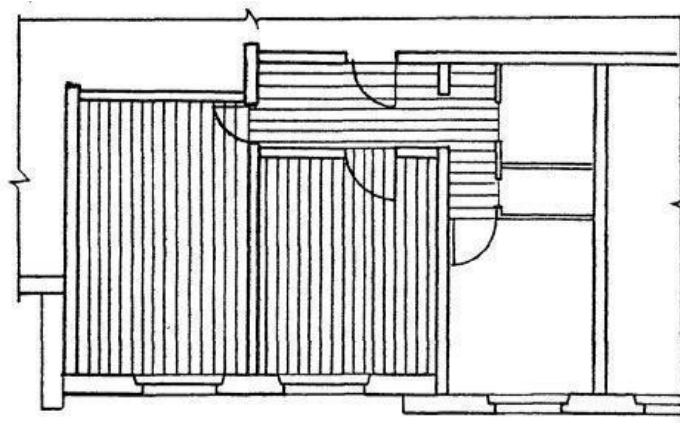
Схема раскладки уширенной паркетной доски в двухкомнатной квартире
